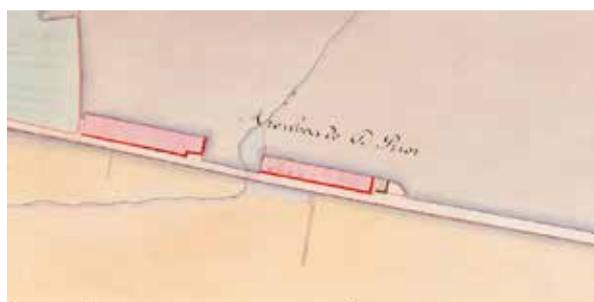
Pormenor da Carta Cadastral de 1868-1869, com projeto de alargamento do cais e rampas para carga e descarga das embarcações
